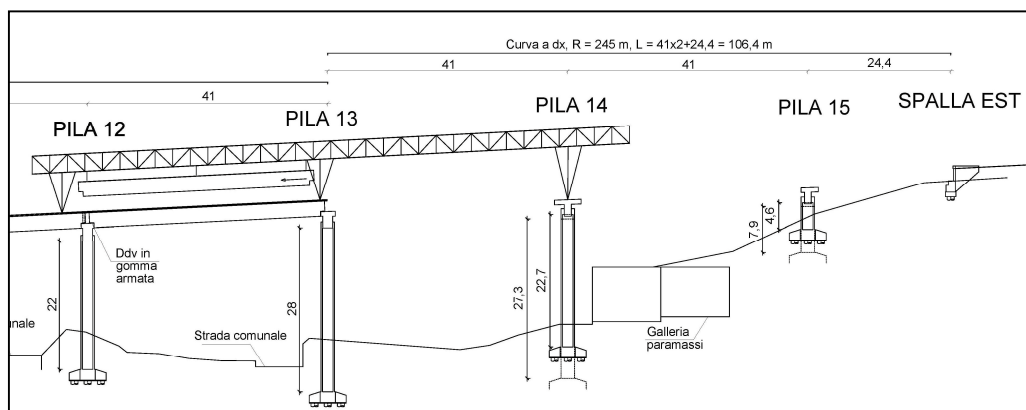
Cantierizzazione n. 2 - fase 1.3
